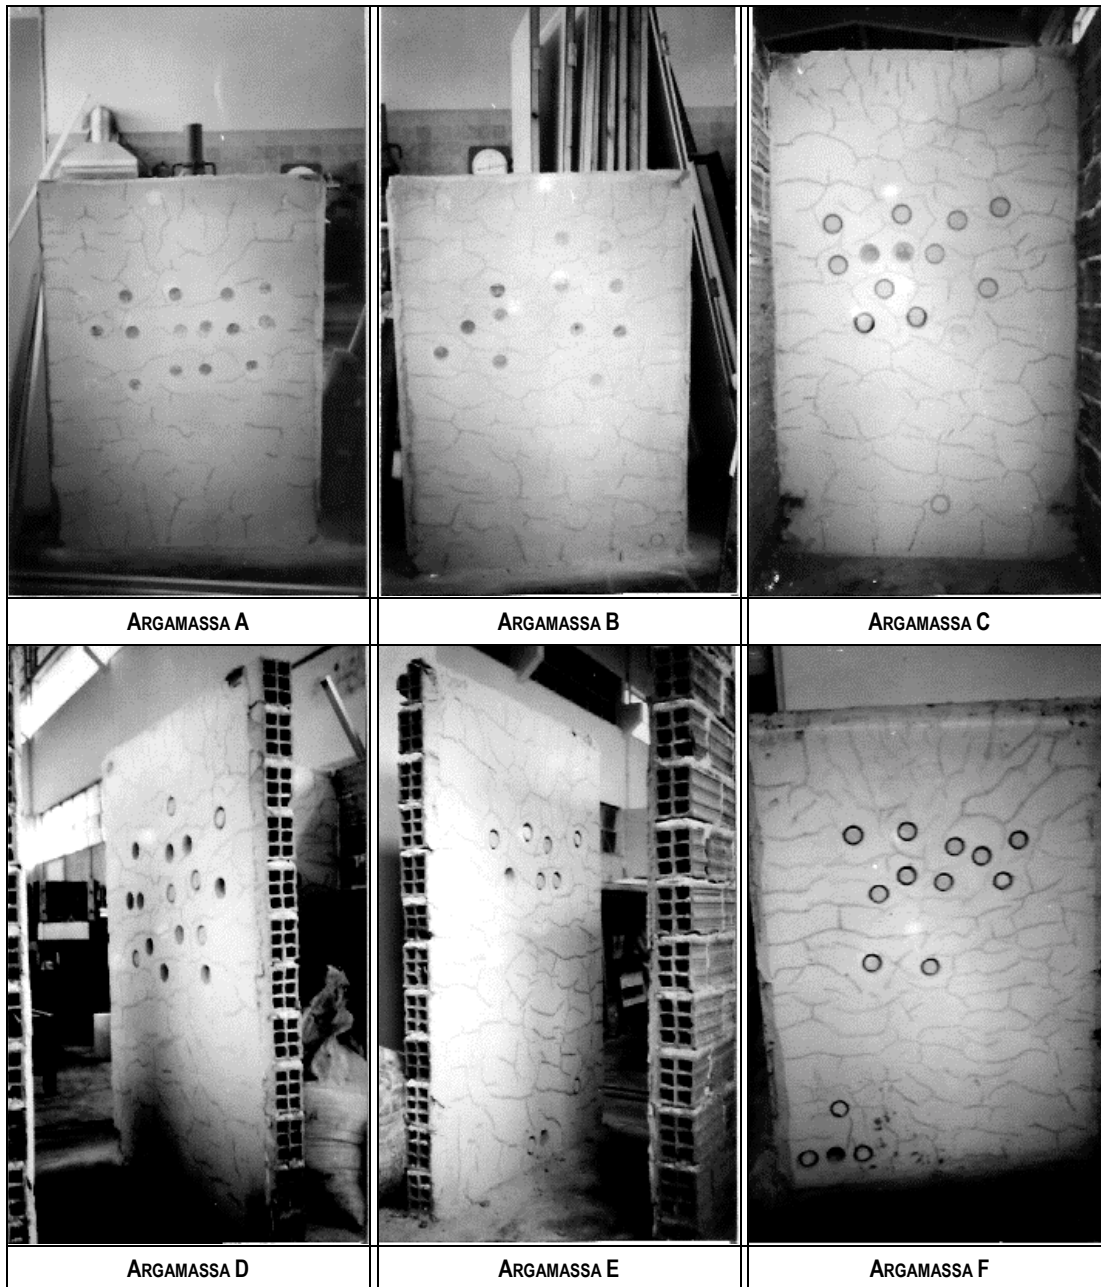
Aspecto de fissuração dos painéis de revestimento ensaiados.
